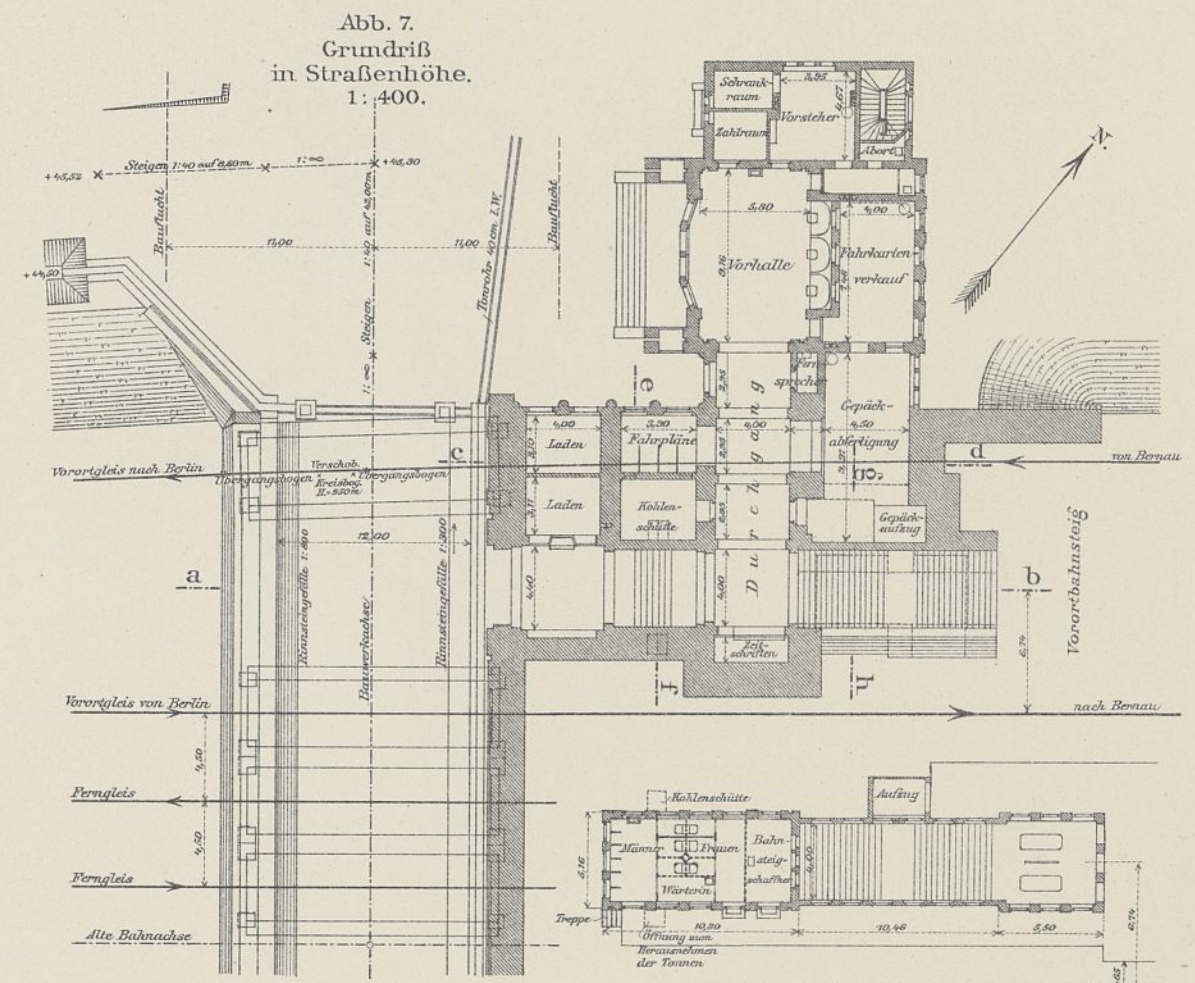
Grundriß in Straßenhöhe. 1: 400.
